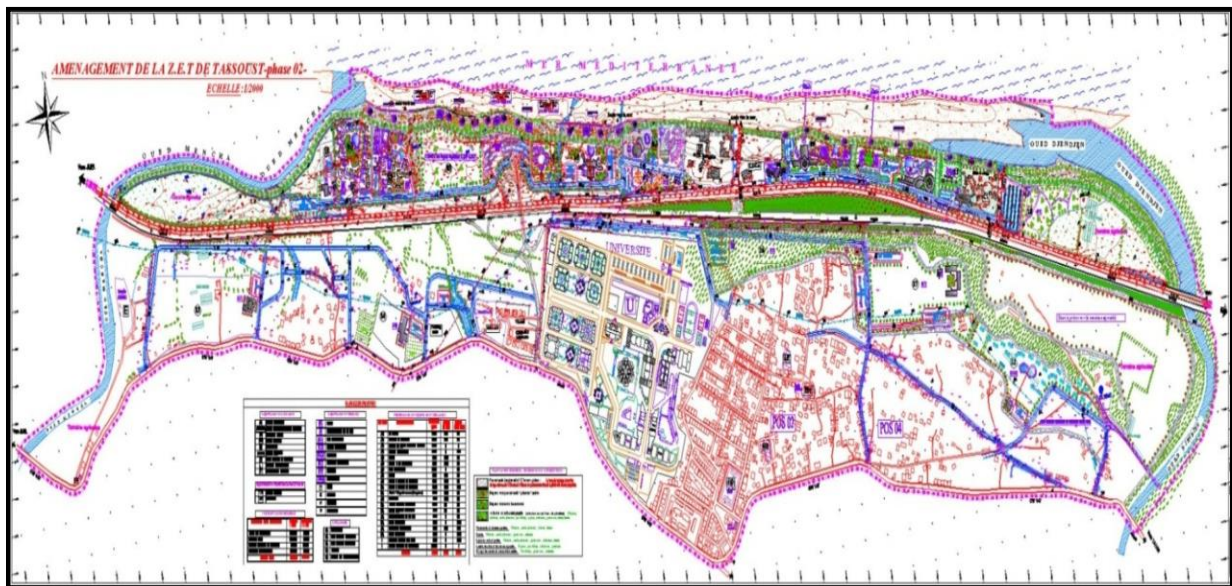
Le plan d'aménagement général de la ZET de TASSOUST
